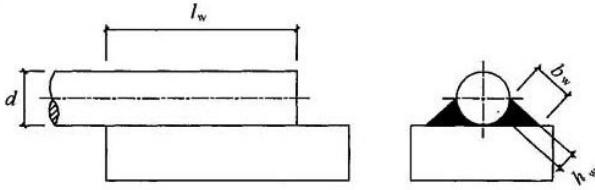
柱纵向钢筋与钢节点竖板连接示意图
